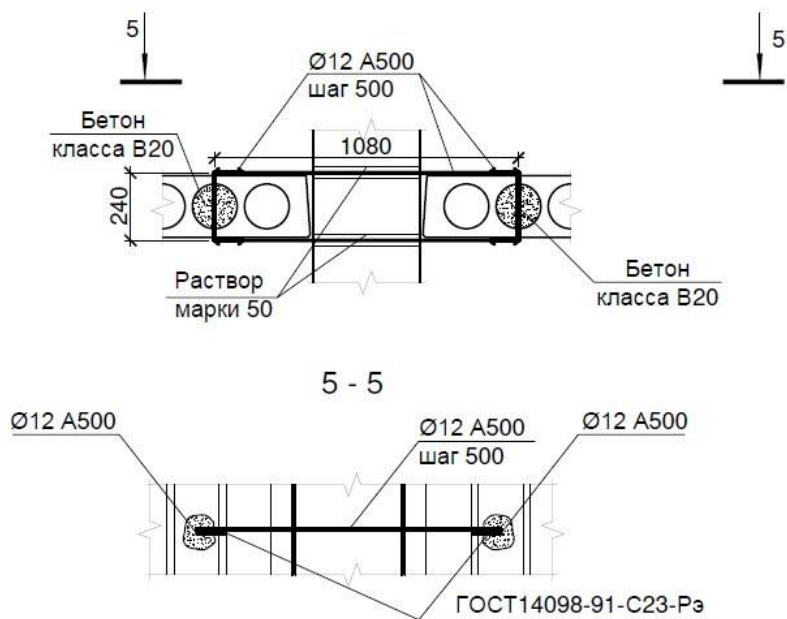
Узел связи плит перекрытий, примыкающих к стенам, между собой
